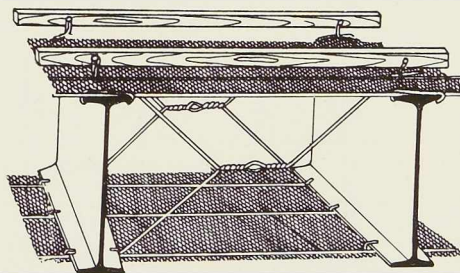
Plancher avec dalles coulées sur métal déployé.
